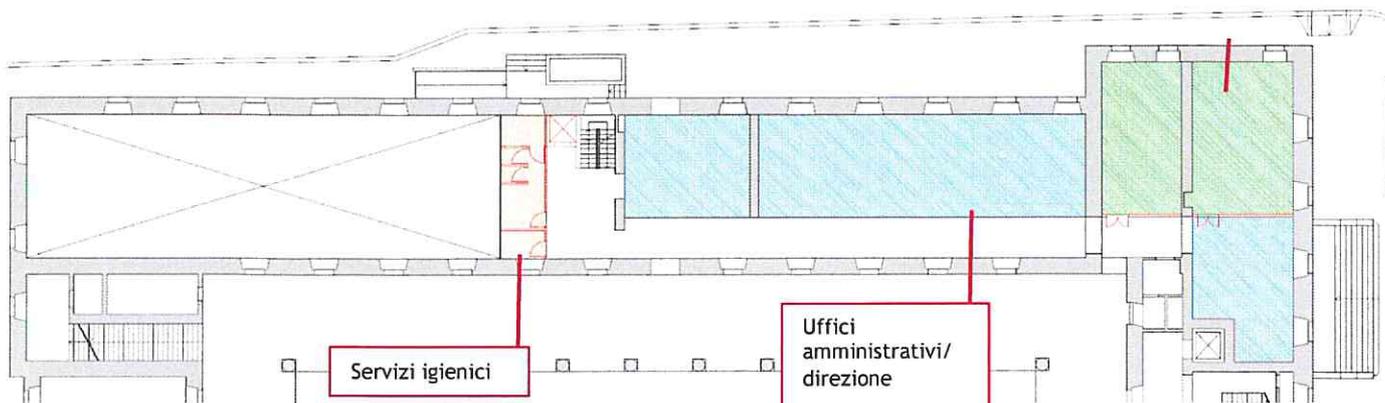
\_Planimetrie funzionali della soluzione progettuale del Piano primo;
